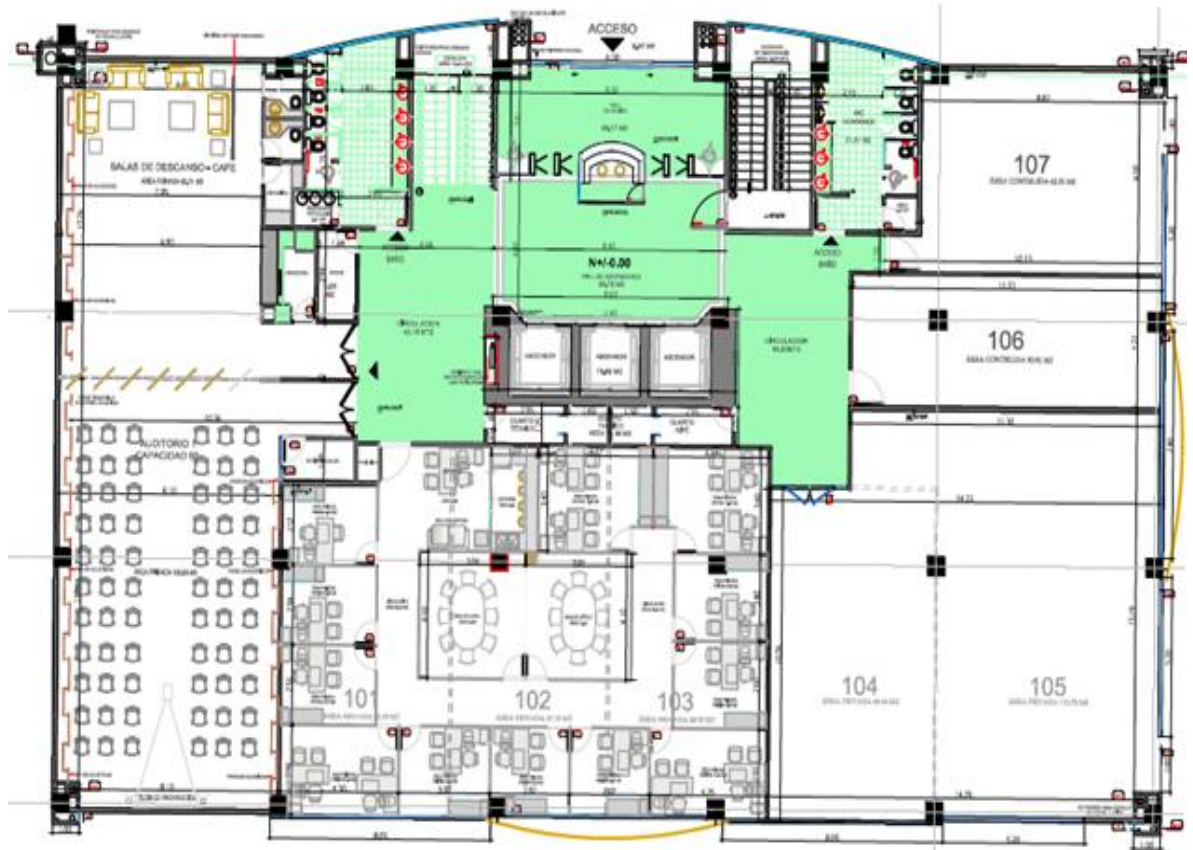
Planos arquitectónicos pisos 2, 3, 4, y 5..
